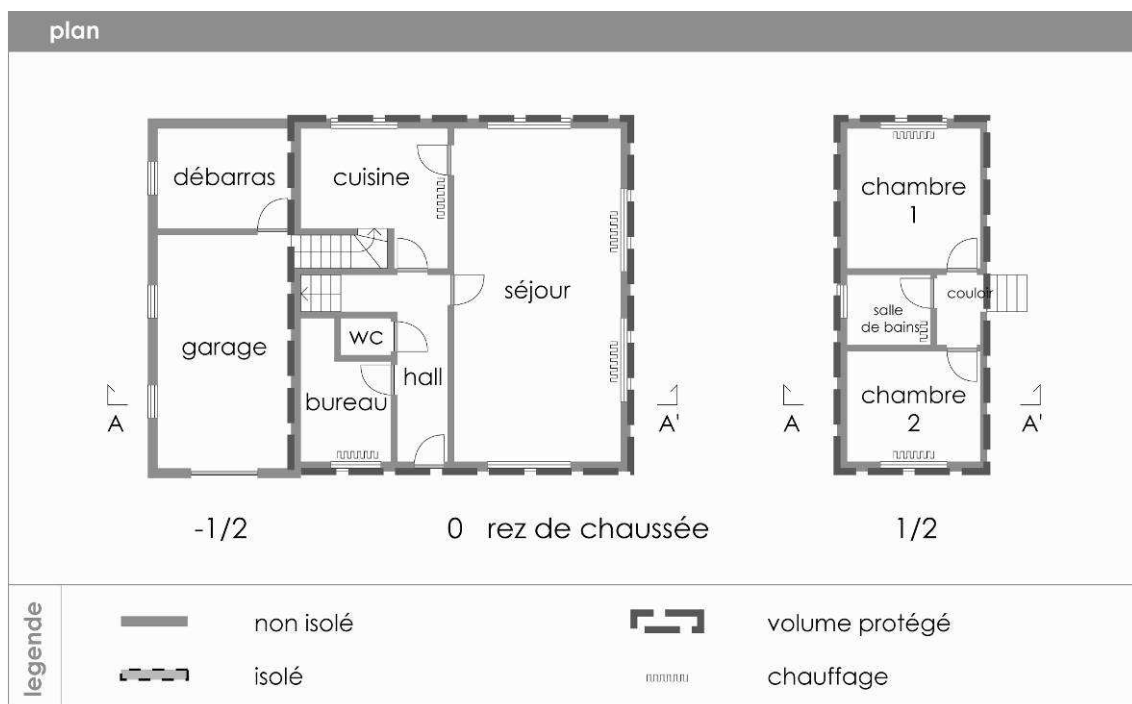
Plan au sol d'une villa (split-level) avec garage et remise semi-enterrés
